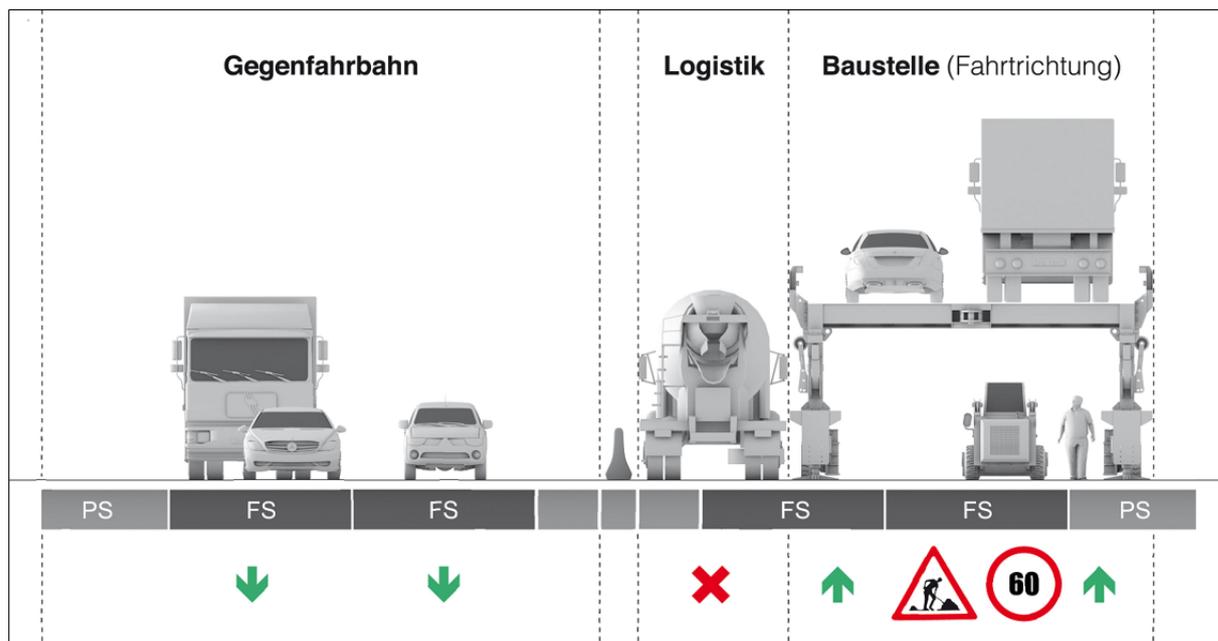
Baustelle Bereich ASTRA Bridge (ASTRA Bridge Faktenblatt, 2024)
